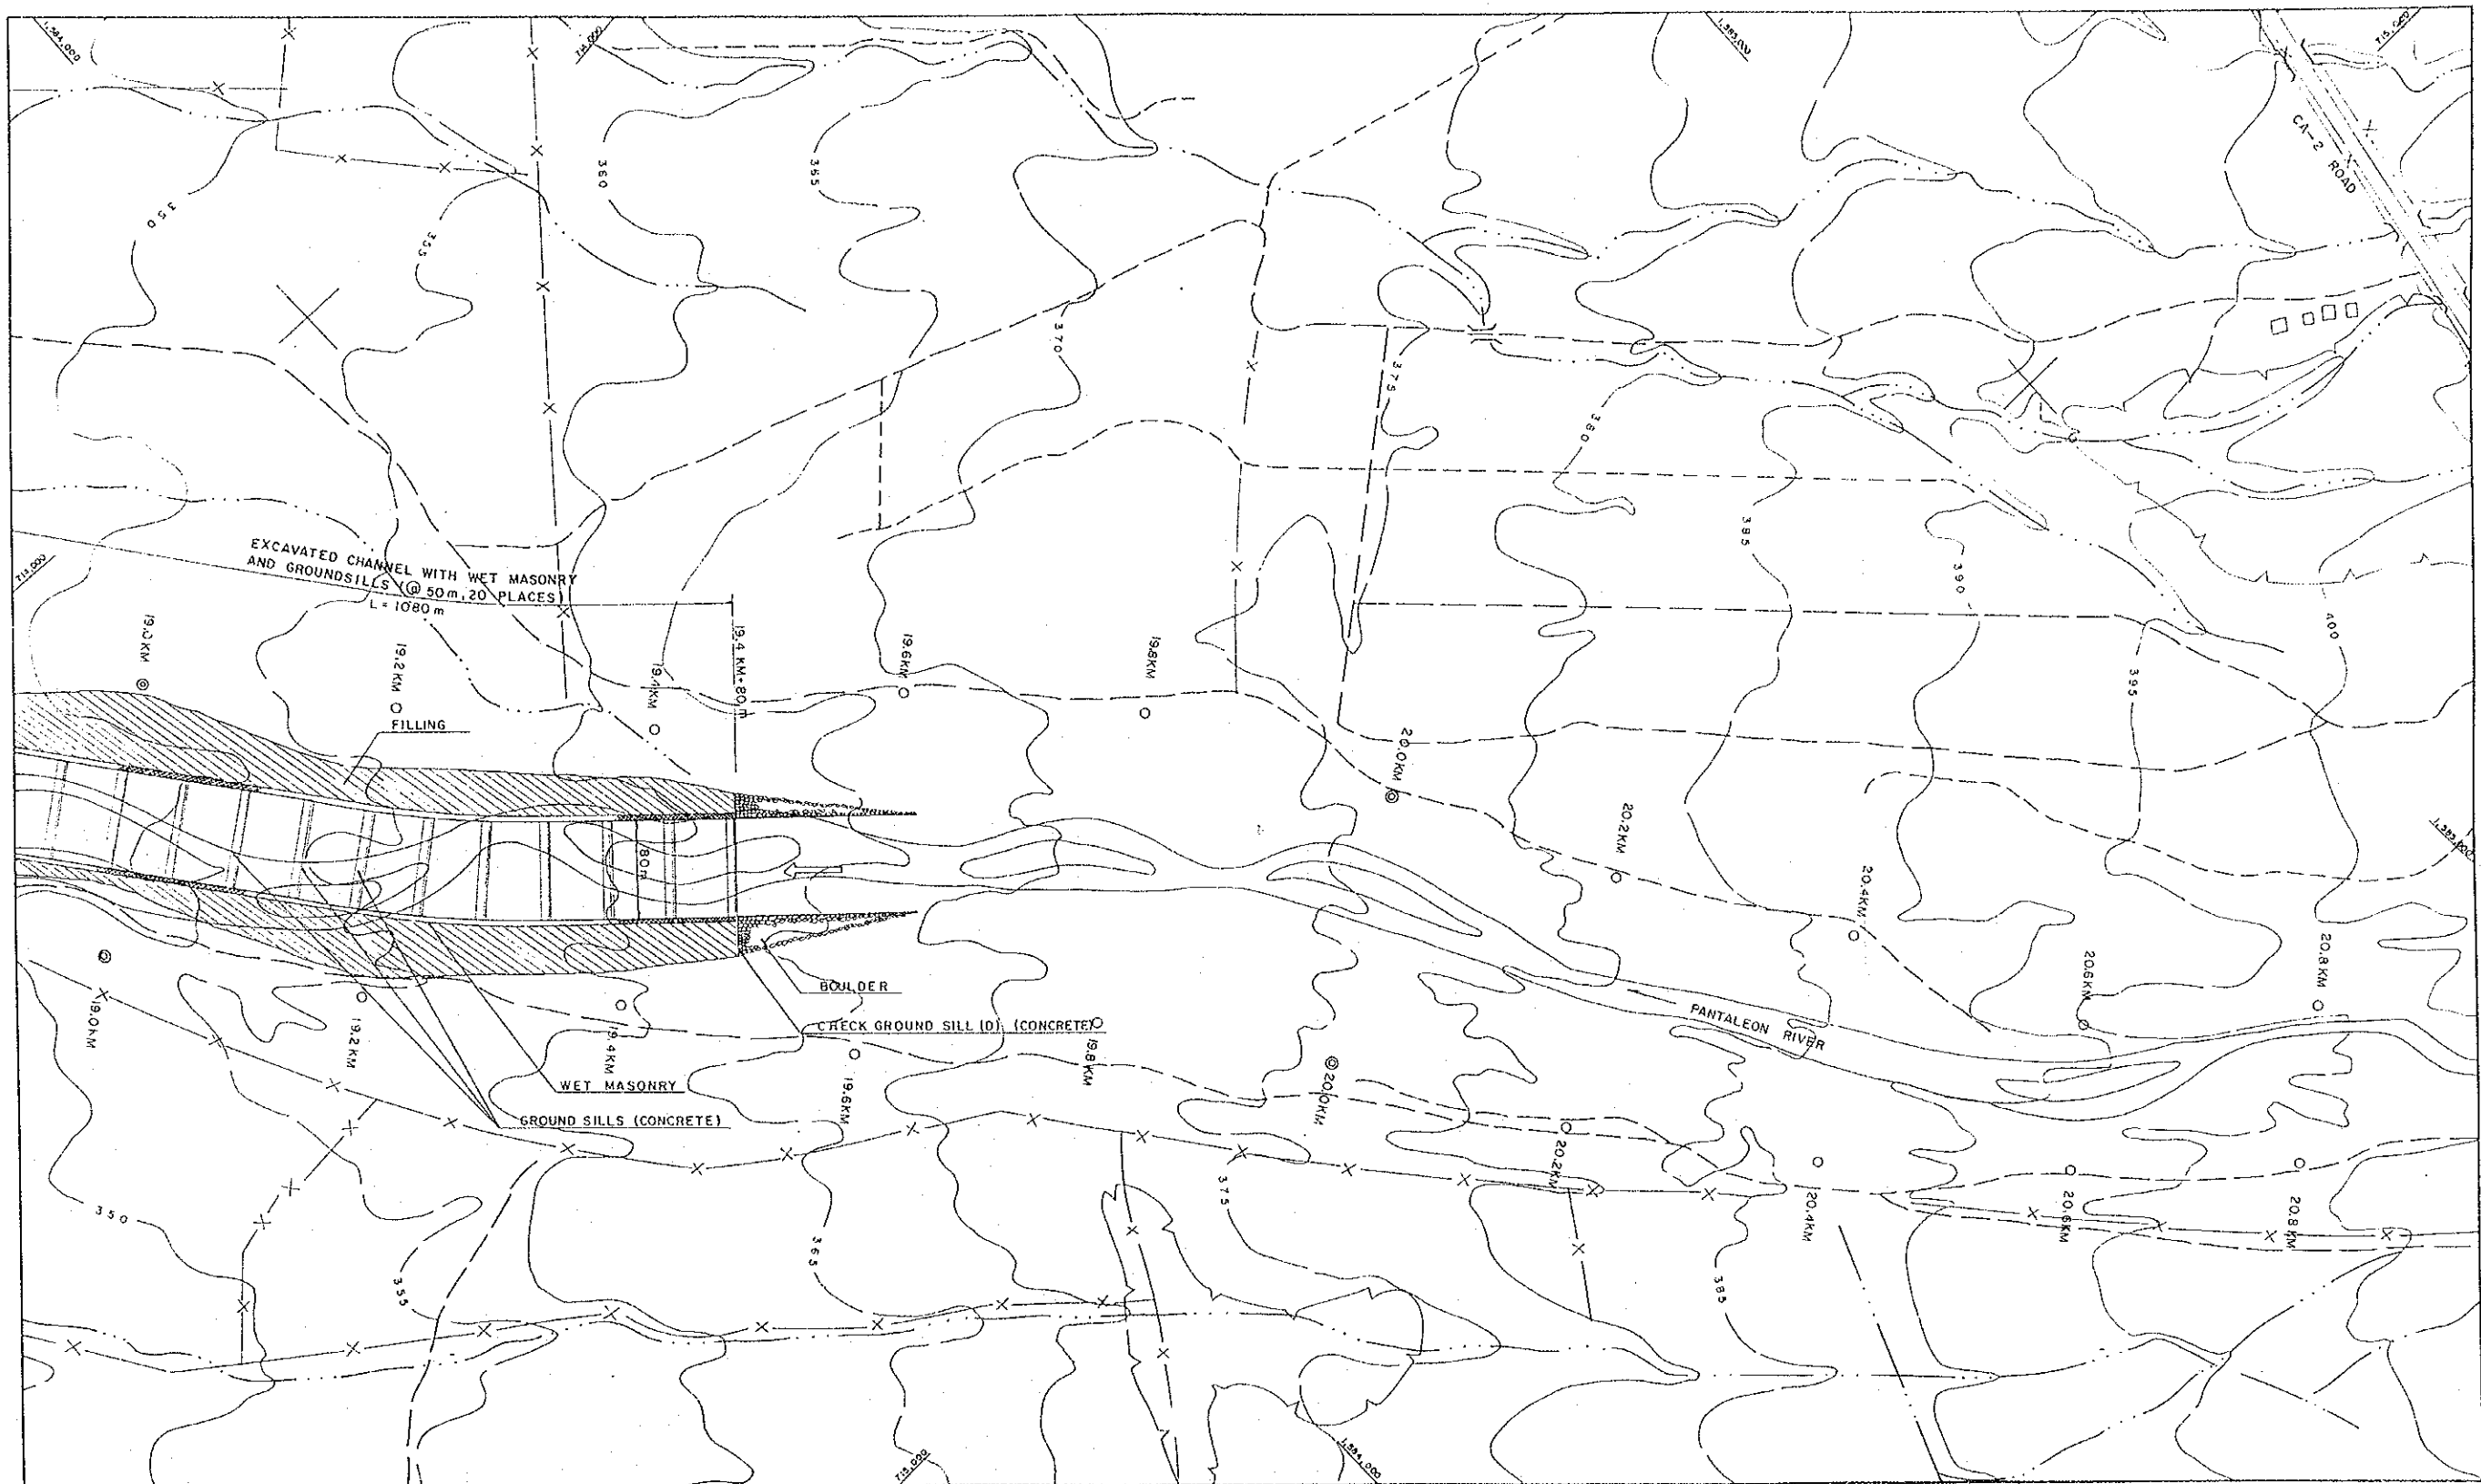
(3/6) PLAN DE MEJORAMIENTO DEL CAUCE (PLAN PROPUESTO) (RIO ACHIGUATE)
